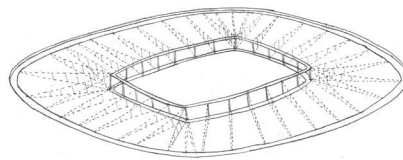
Diagrama del comportamiento estructural de las cubiertas tensadas de la tipología *Anillos* y subtipo *Cables*. Elaboración propia.
